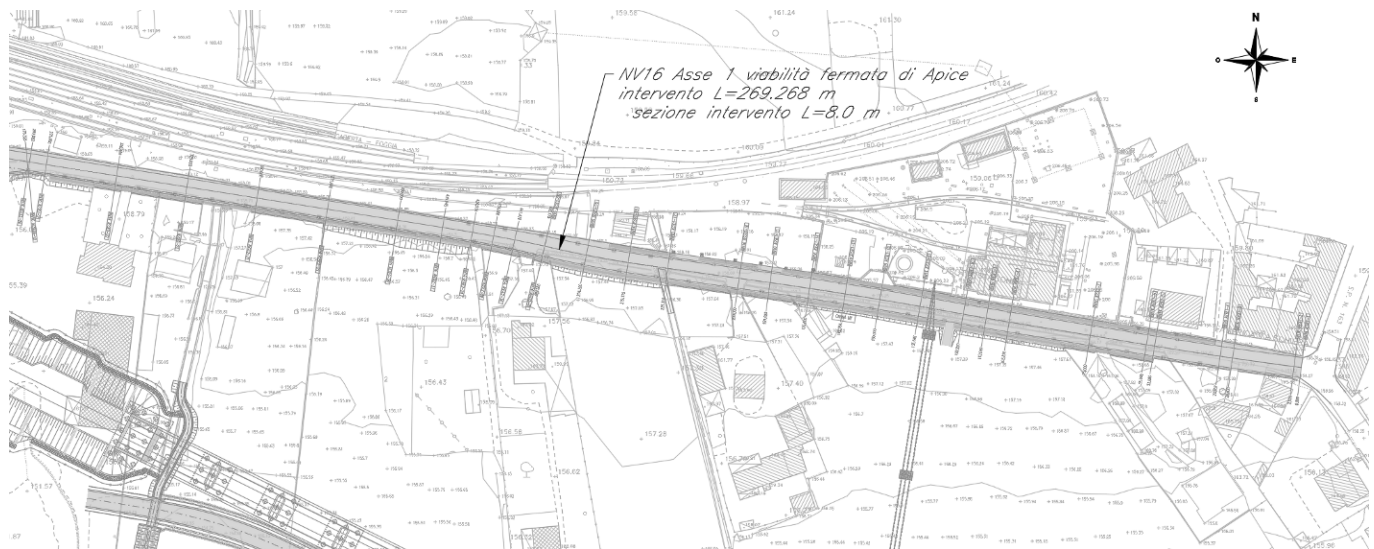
Planimetria di progetto NV16 Asse 1
